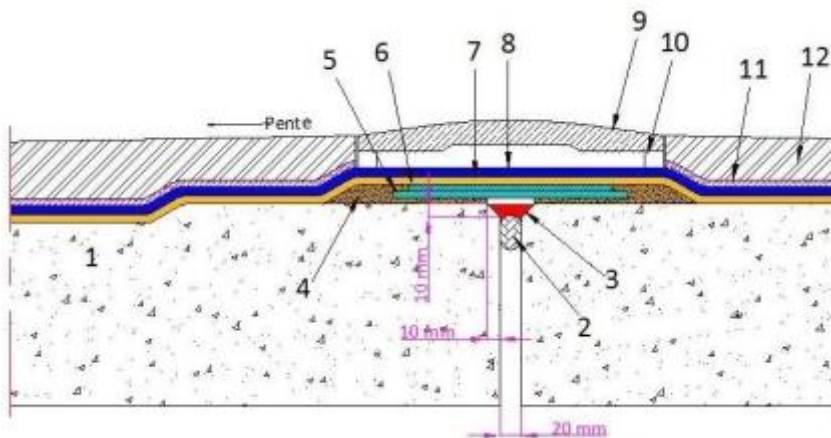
Joint de dilatation : terrasse parking sous protection lourde dure
